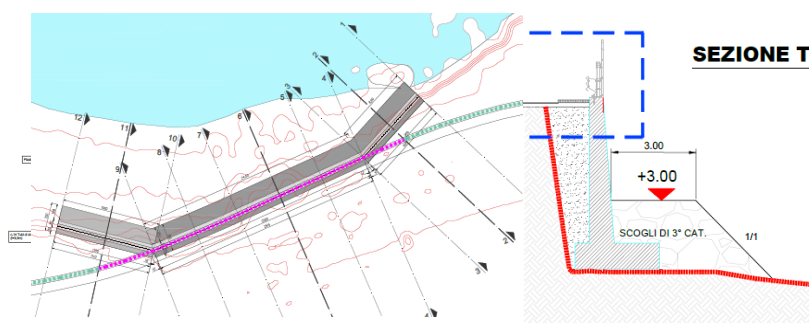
Elab. A-I-24-6 Intervento 24 Parete tirantata profilo di progetto
